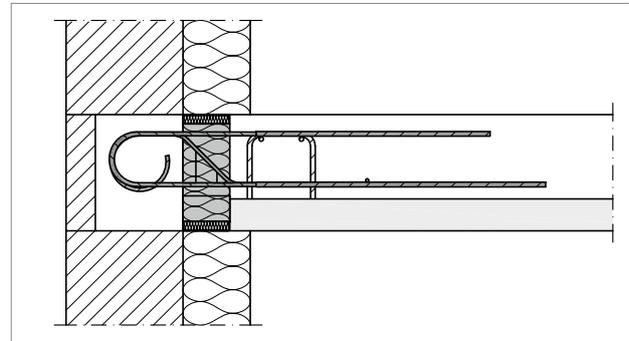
Schöck Rutherma® T type DF : liaison pour façade en maçonnerie et plancher constitué de prédalles
